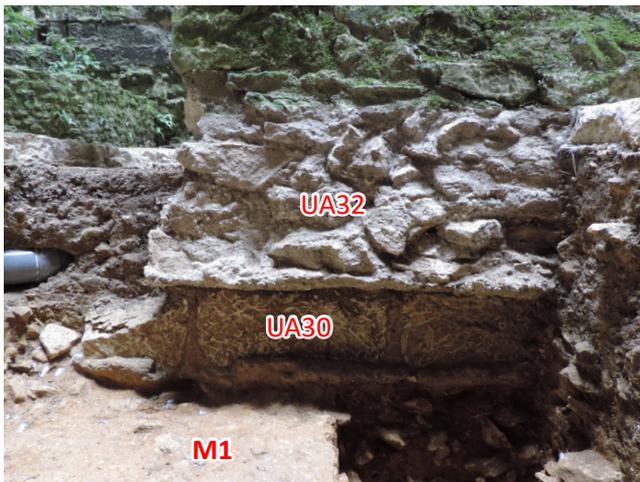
photographie de détail de la fondation du mur de refend mise au jour dans le sondage 1 (face nord)
